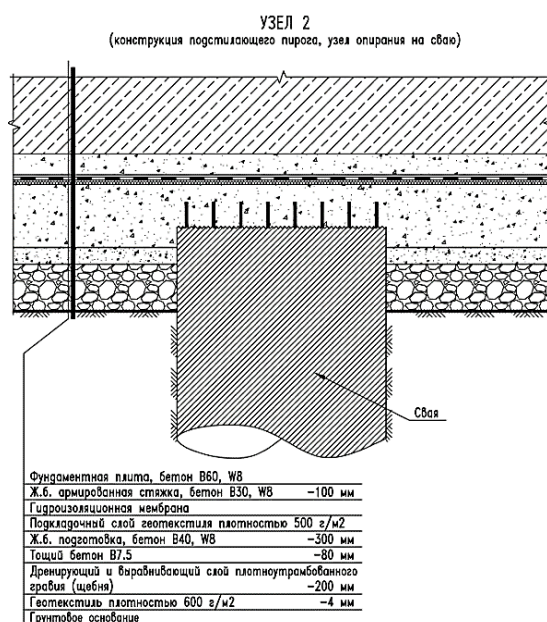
Заделка свай в железобетонную подготовку под фундаментной плитой
